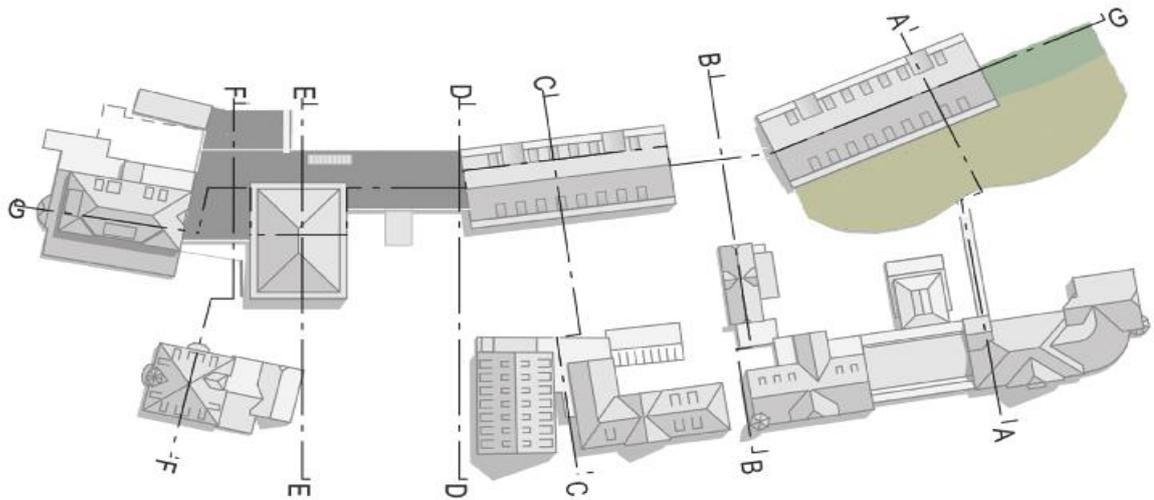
Grundriss Hotel Alpenrose mit Hotelneubau und Angabe der Schnittführung und Lage des Verbindungsbaus zum bestehenden Hotel Alpenrose sowie Längsschnitt gemäß vorläufigem Vorentwurf, wobei sich die Gebäude innerhalb der Baugrenze noch leicht verschieben können. Dies gilt auch für die Zwischenbauten und die erdüberdeckten Gebäude im rückwärtigen Teil der Neubauten.
